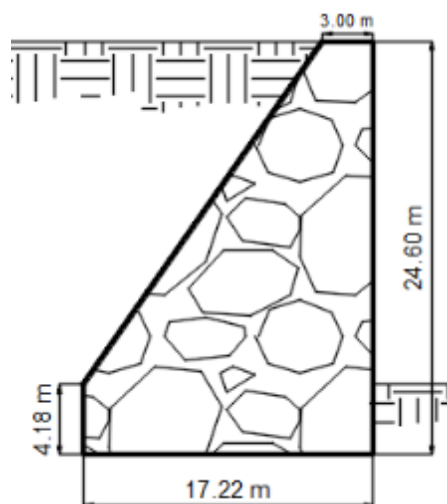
Dimensiones propuesta para el muro de mampostería.
